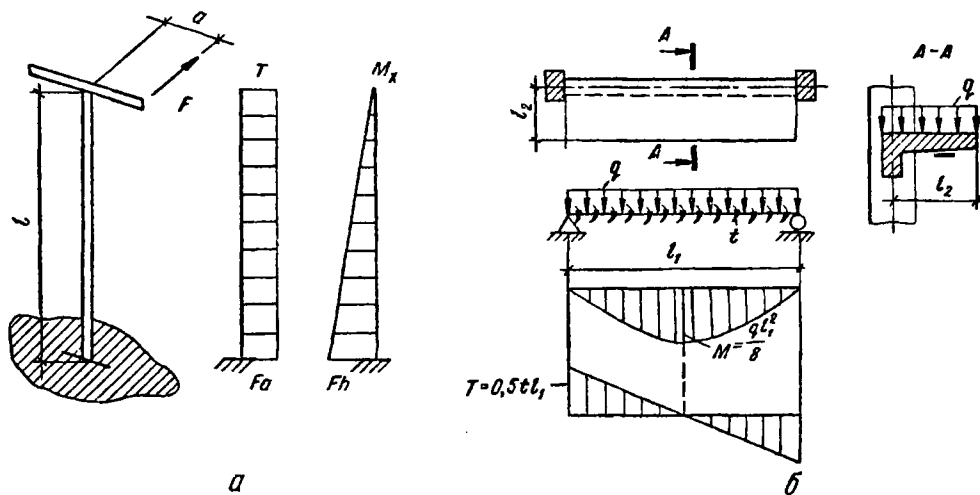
Залізобетонні елементи, що працюють на згинання з крученням:
